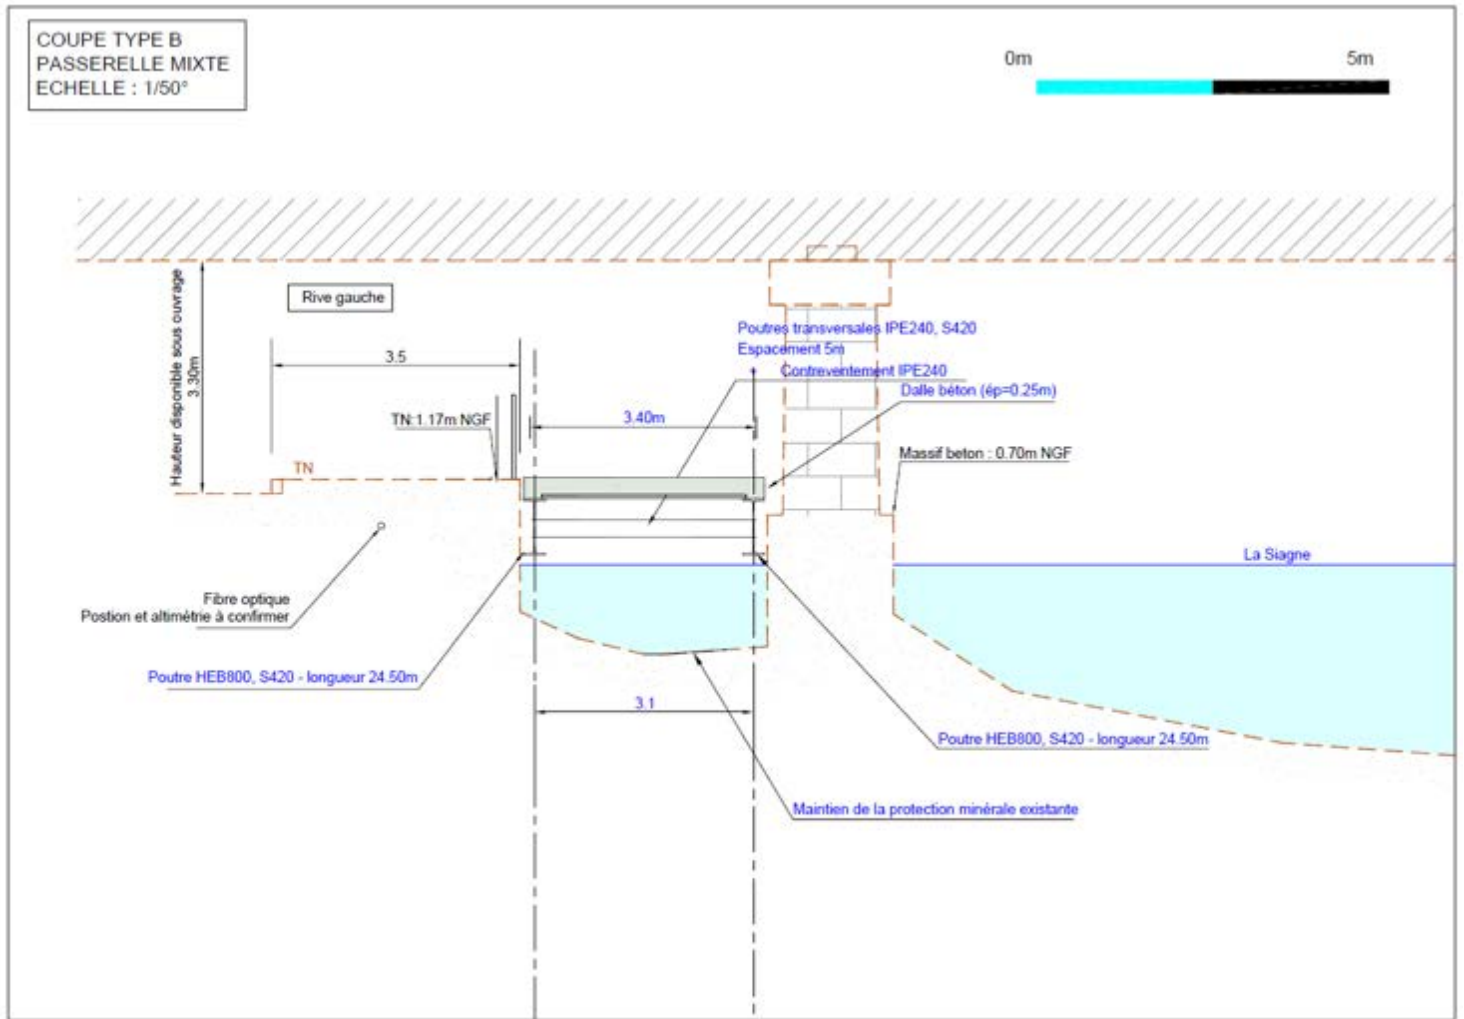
coupe type de la solution passerelle béton au droit du pont SNCF
